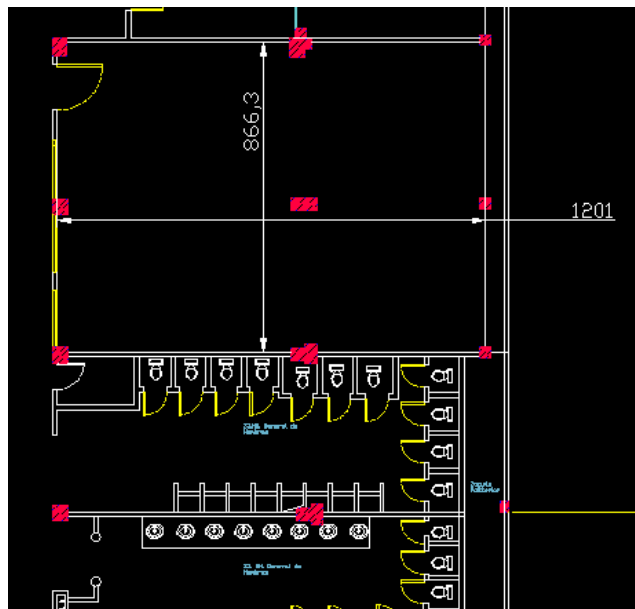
Ubicación del espacio designado para el laboratorio, junto a los baños de varones de la Institución.
